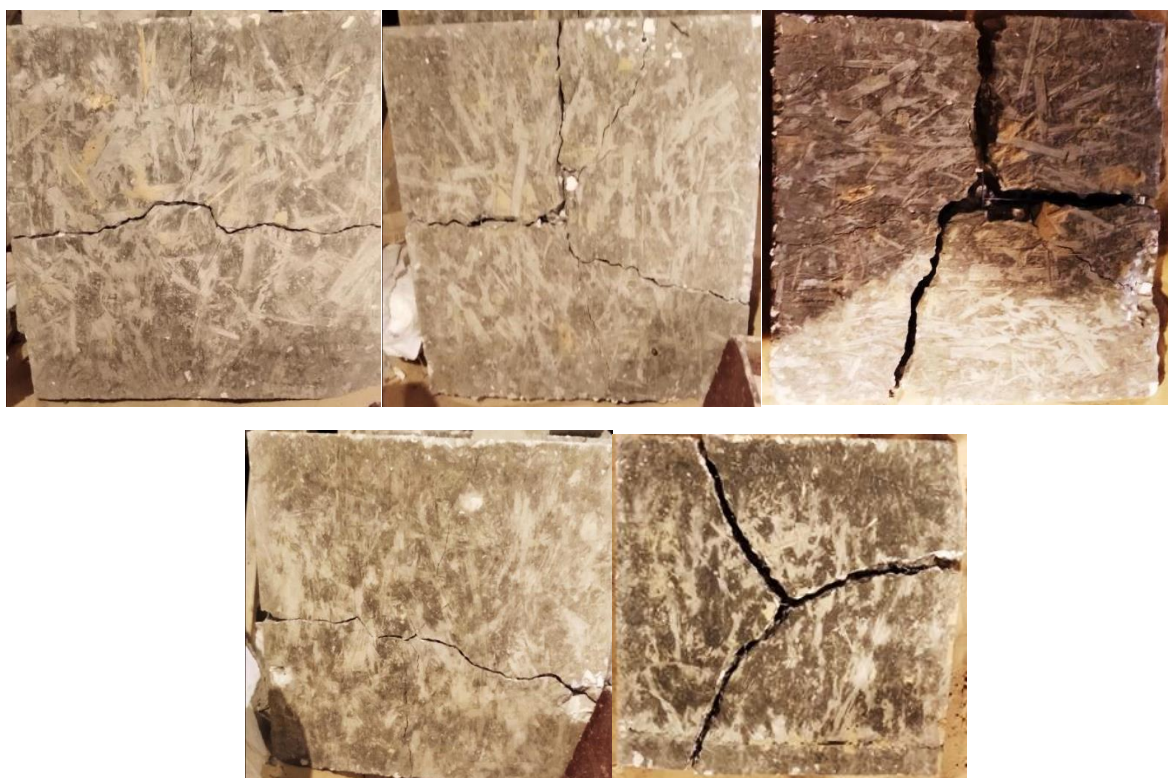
Фундаменты Ф-1 – Ф-5 после разрушения
